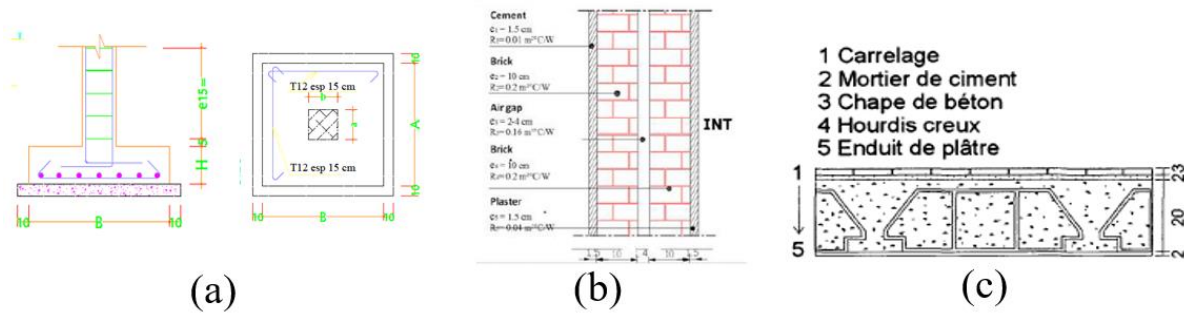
Structure et techniques de construction moderne utilisé, a. Fondation, b. Mur, c. Plancher
